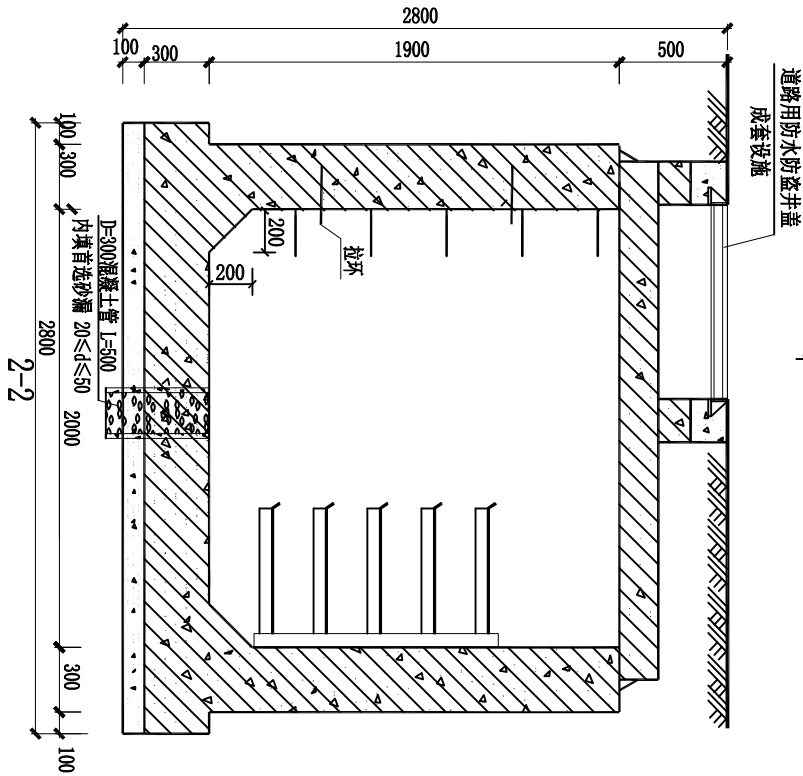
[3.0×2.0×1.9钢筋混凝土直线电缆井 (E-1-13) (三)]
